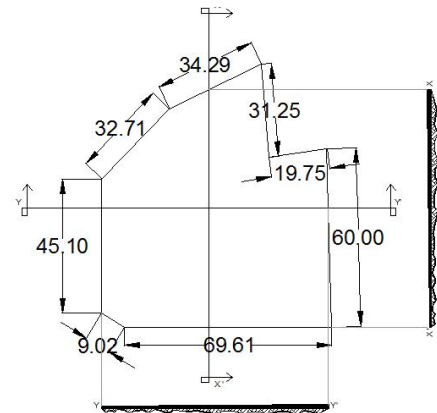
Plano acotado del terreno Fuente Propia s/e.
